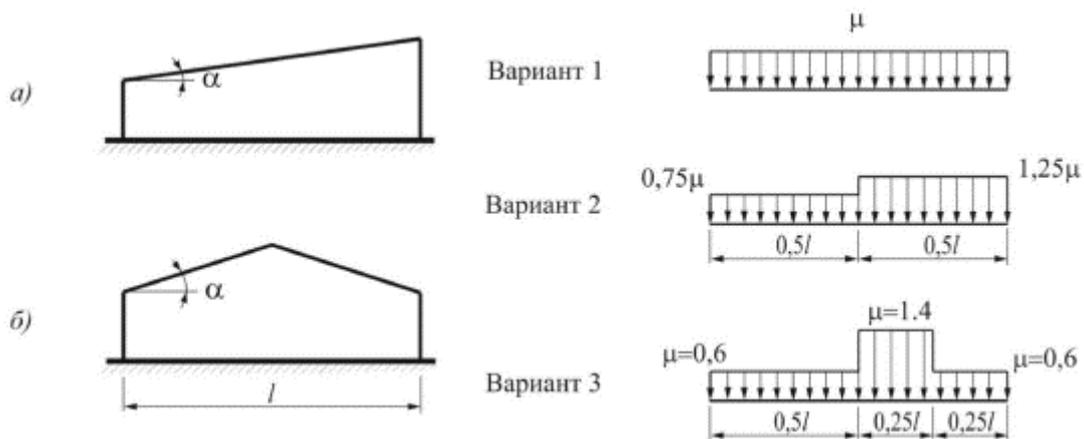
Варианты распределения снеговых нагрузок на односкатную и двускатную кровлю
